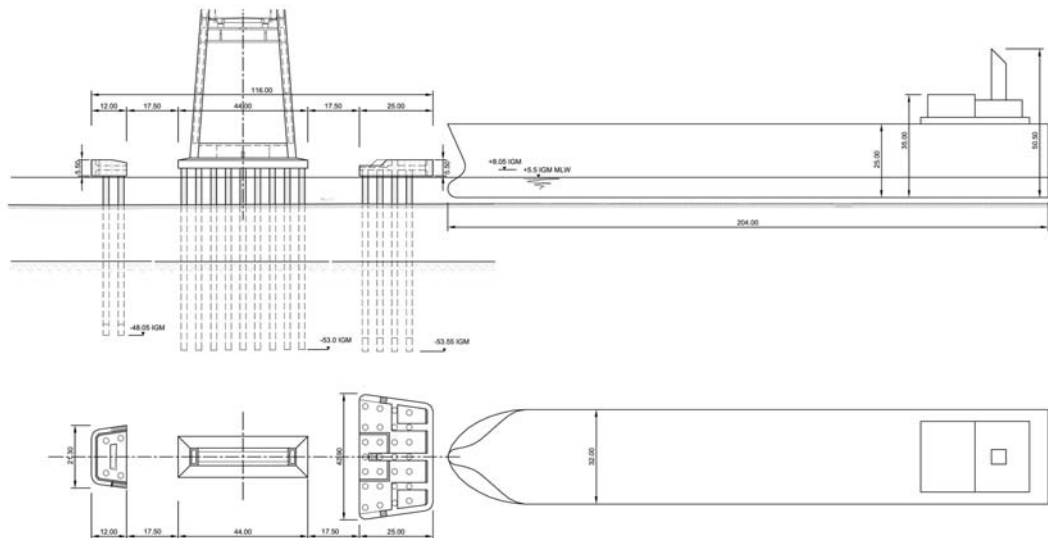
Schiffsabweiserbauwerke der Pylone der Hauptbrücke mit Bemessungsschiff
